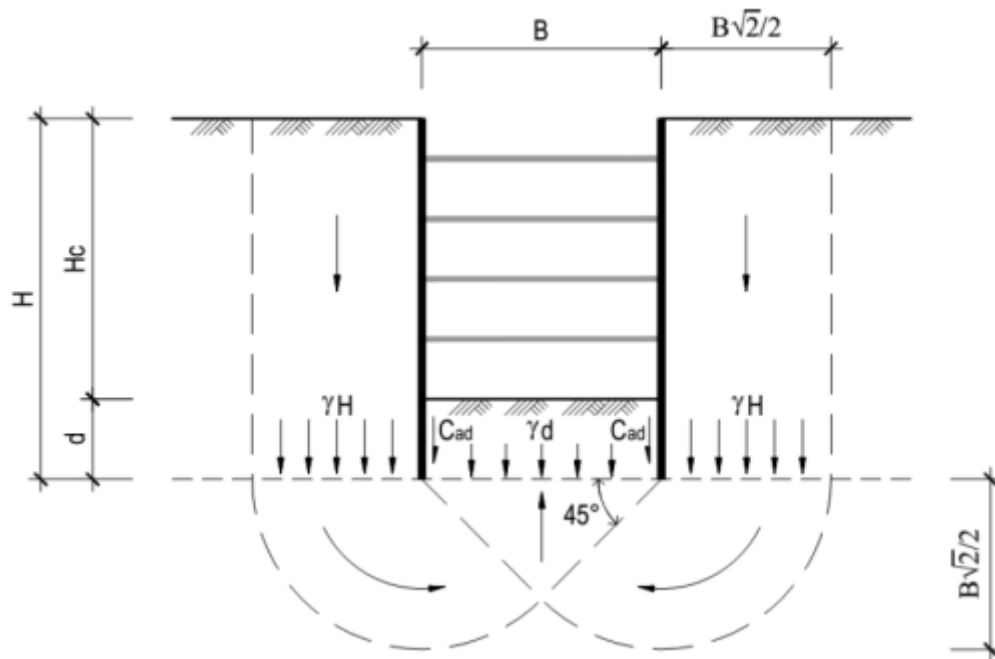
Mécanisme de rupture de la fondation d'une excavation [13].
